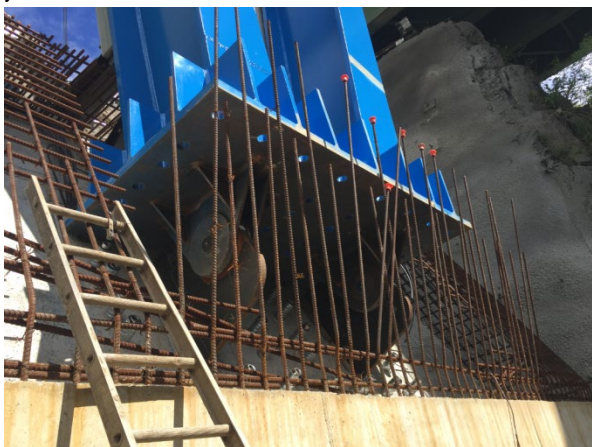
Detalle de la rótula de la pila norte, y perforaciones en la chapa base para enhebrado de barras de postesado entre pila y zapata
